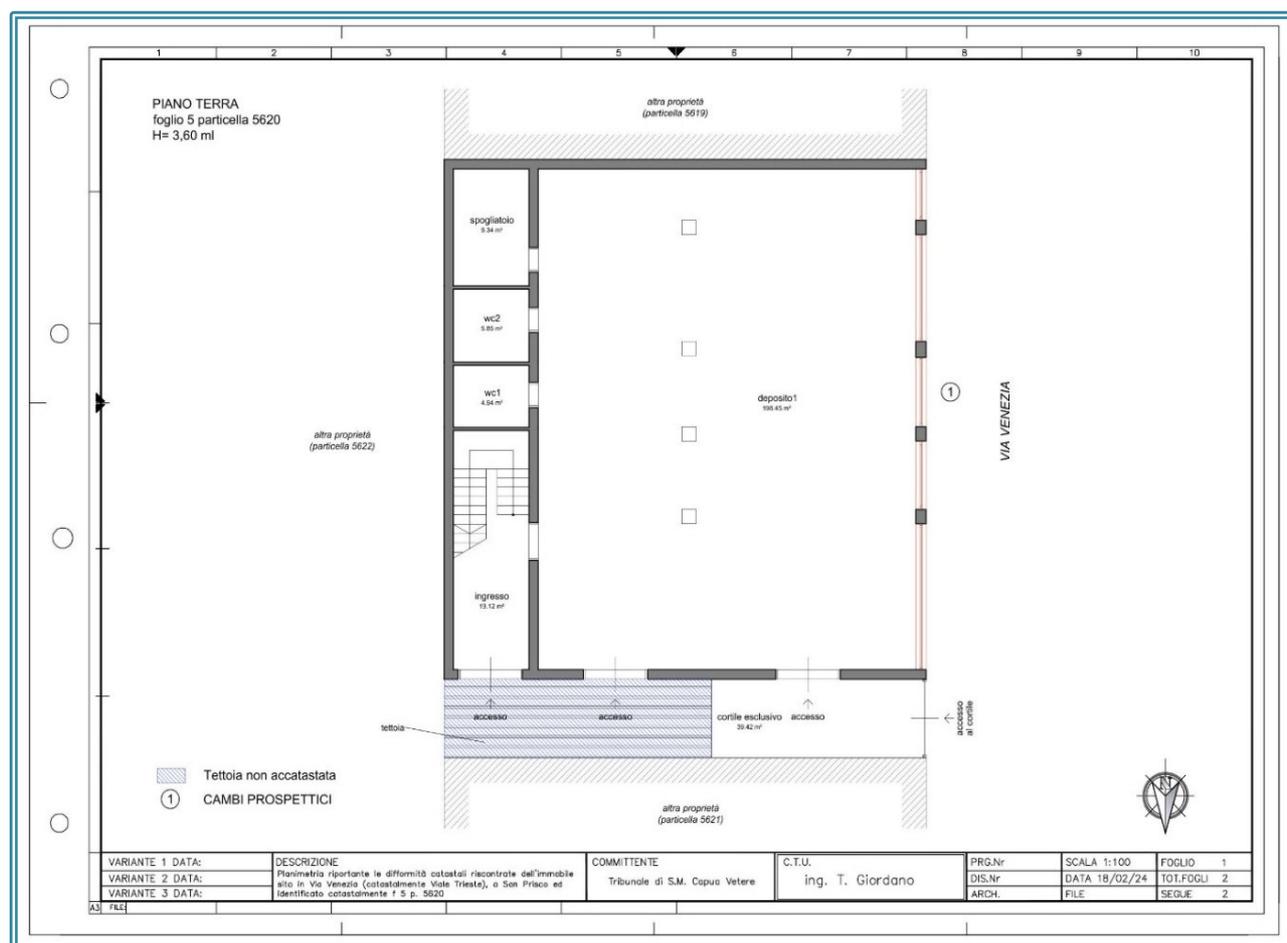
Schema difformità LOTTO 13 (Piano Terra)
